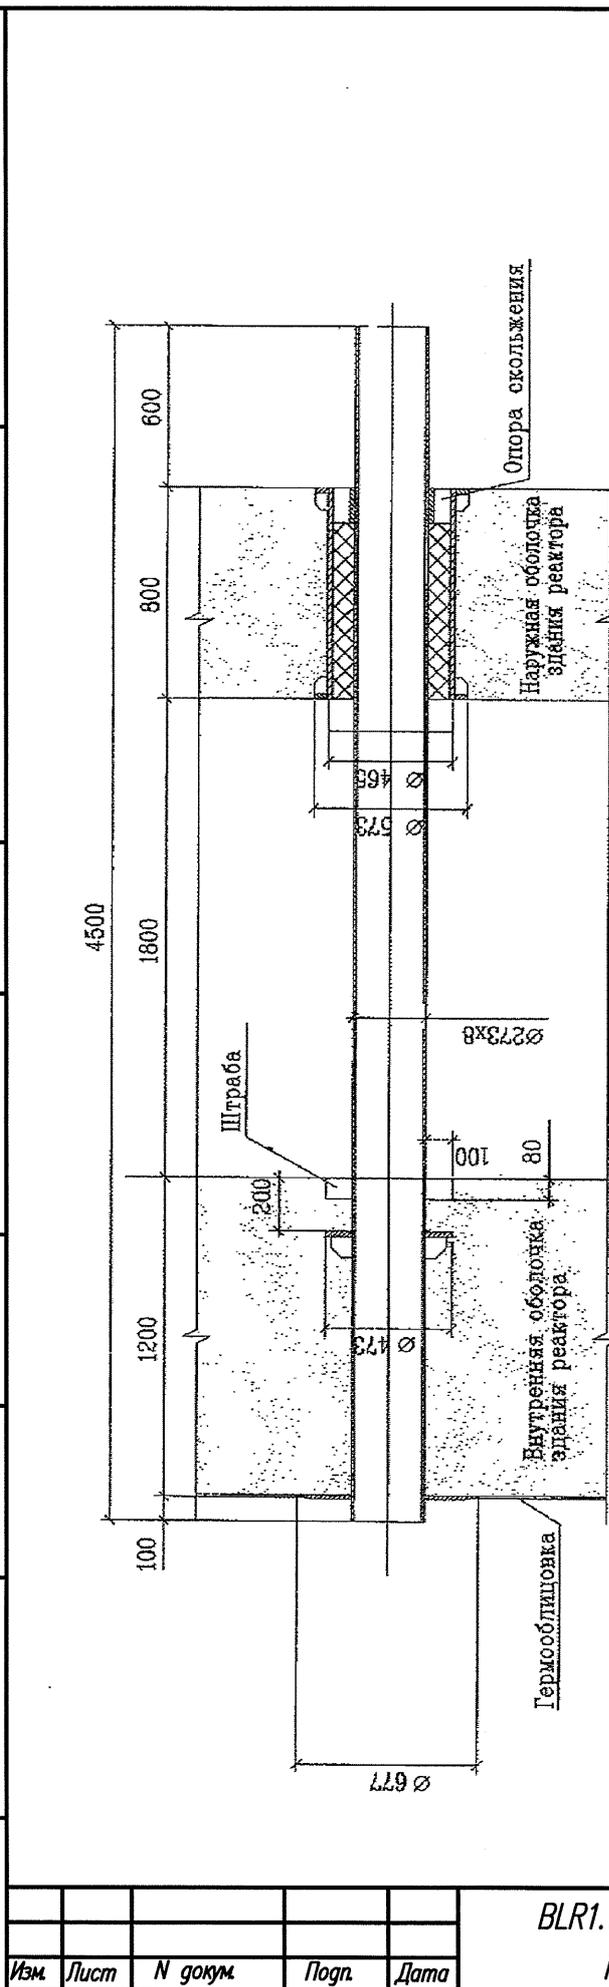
Габаритный чертеж герметичной проходки вентиляционных коробов
